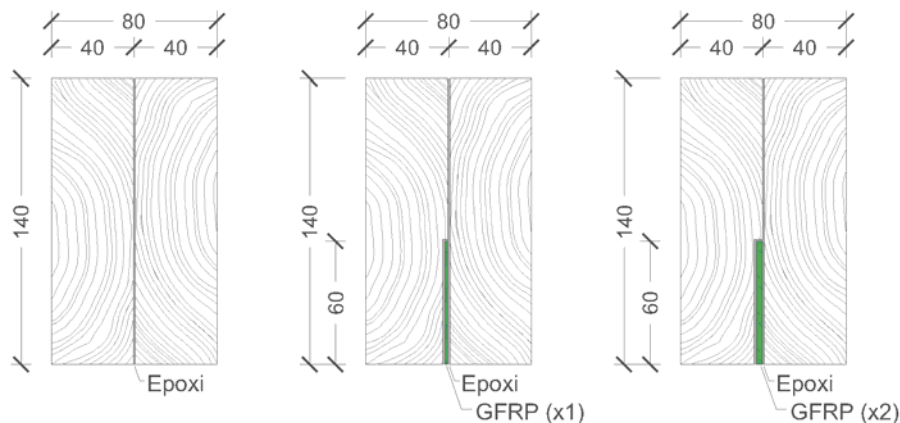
Disposición de refuerzos y dimensiones de las vigas dúo ensayadas.
